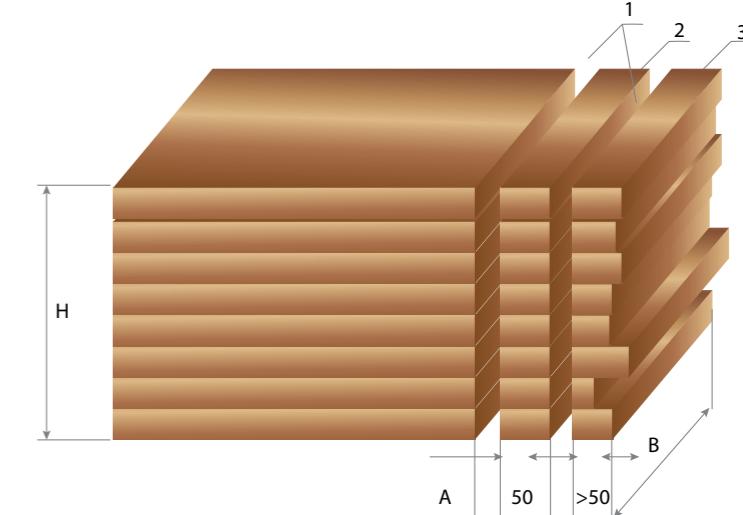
Отбор образцов: А – проектный размер конструкции; Н – высота конструкции; В – ширина конструкции; 1 – пропилы; 2 – заготовка для образцов; 3 – отпад
